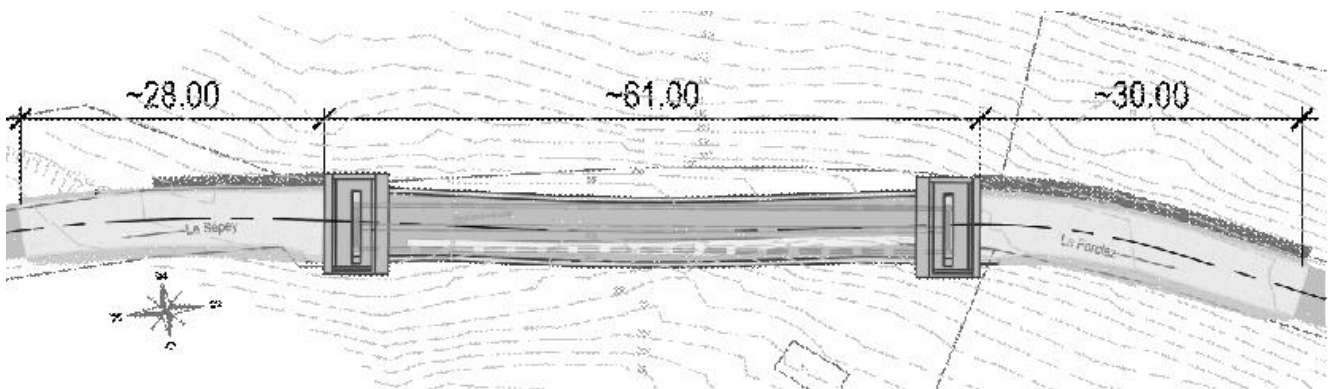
plan de situation du pont et des tronçons de chaussées adjacents remis en état
